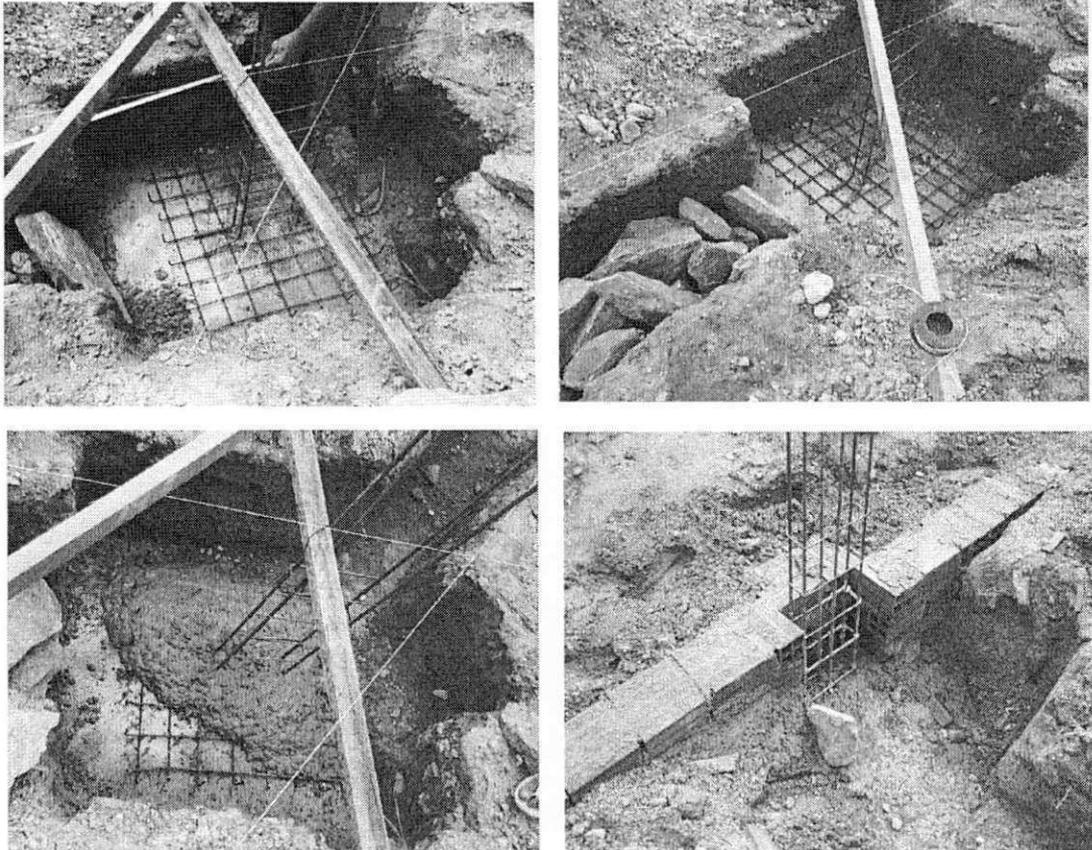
a 51 – Colocação da ferragem nas sapatas e fiada de tijolos para o nivelamento
